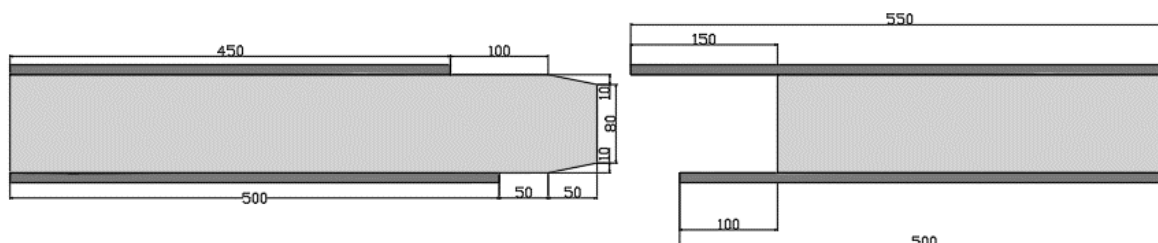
Vista em planta do sistema de encaixe macho-fêmea do protótipo 1 (fase final).
